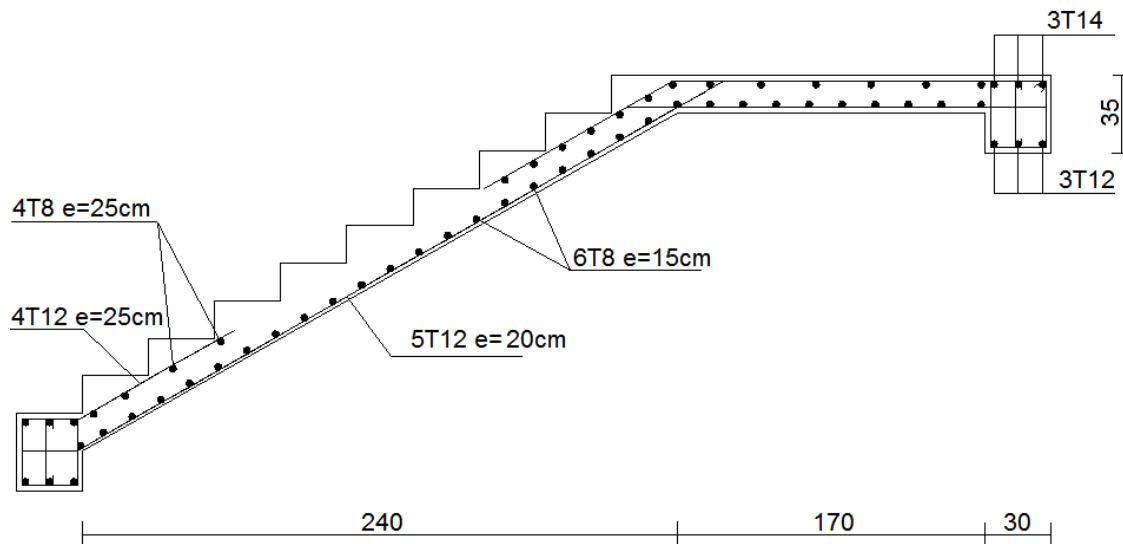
Schéma de ferrailage des escaliers et poutre palière.
